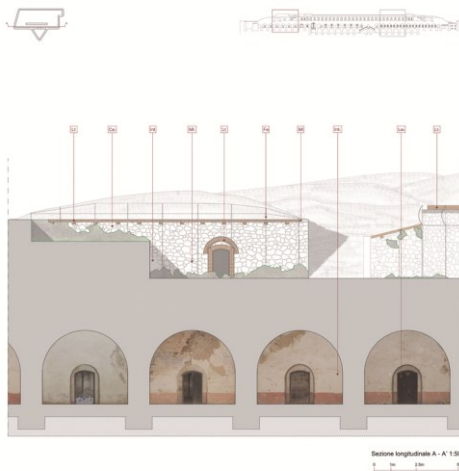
Forte Siacchi: sezione delle gallerie (1)
